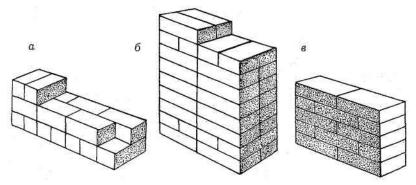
Варианты кирпичной кладки стен беседки: а, б — кладка в один кирпич; в — кладка в полкирпича
